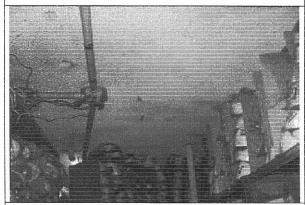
Cara inferior de la placa de cubierta en buenas condiciones
